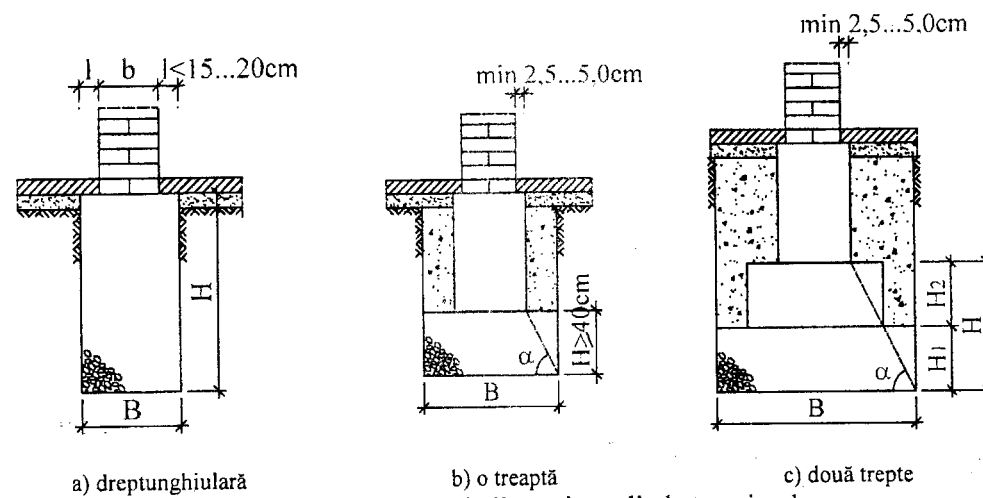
Tipuri de fundații continue din beton simplu
